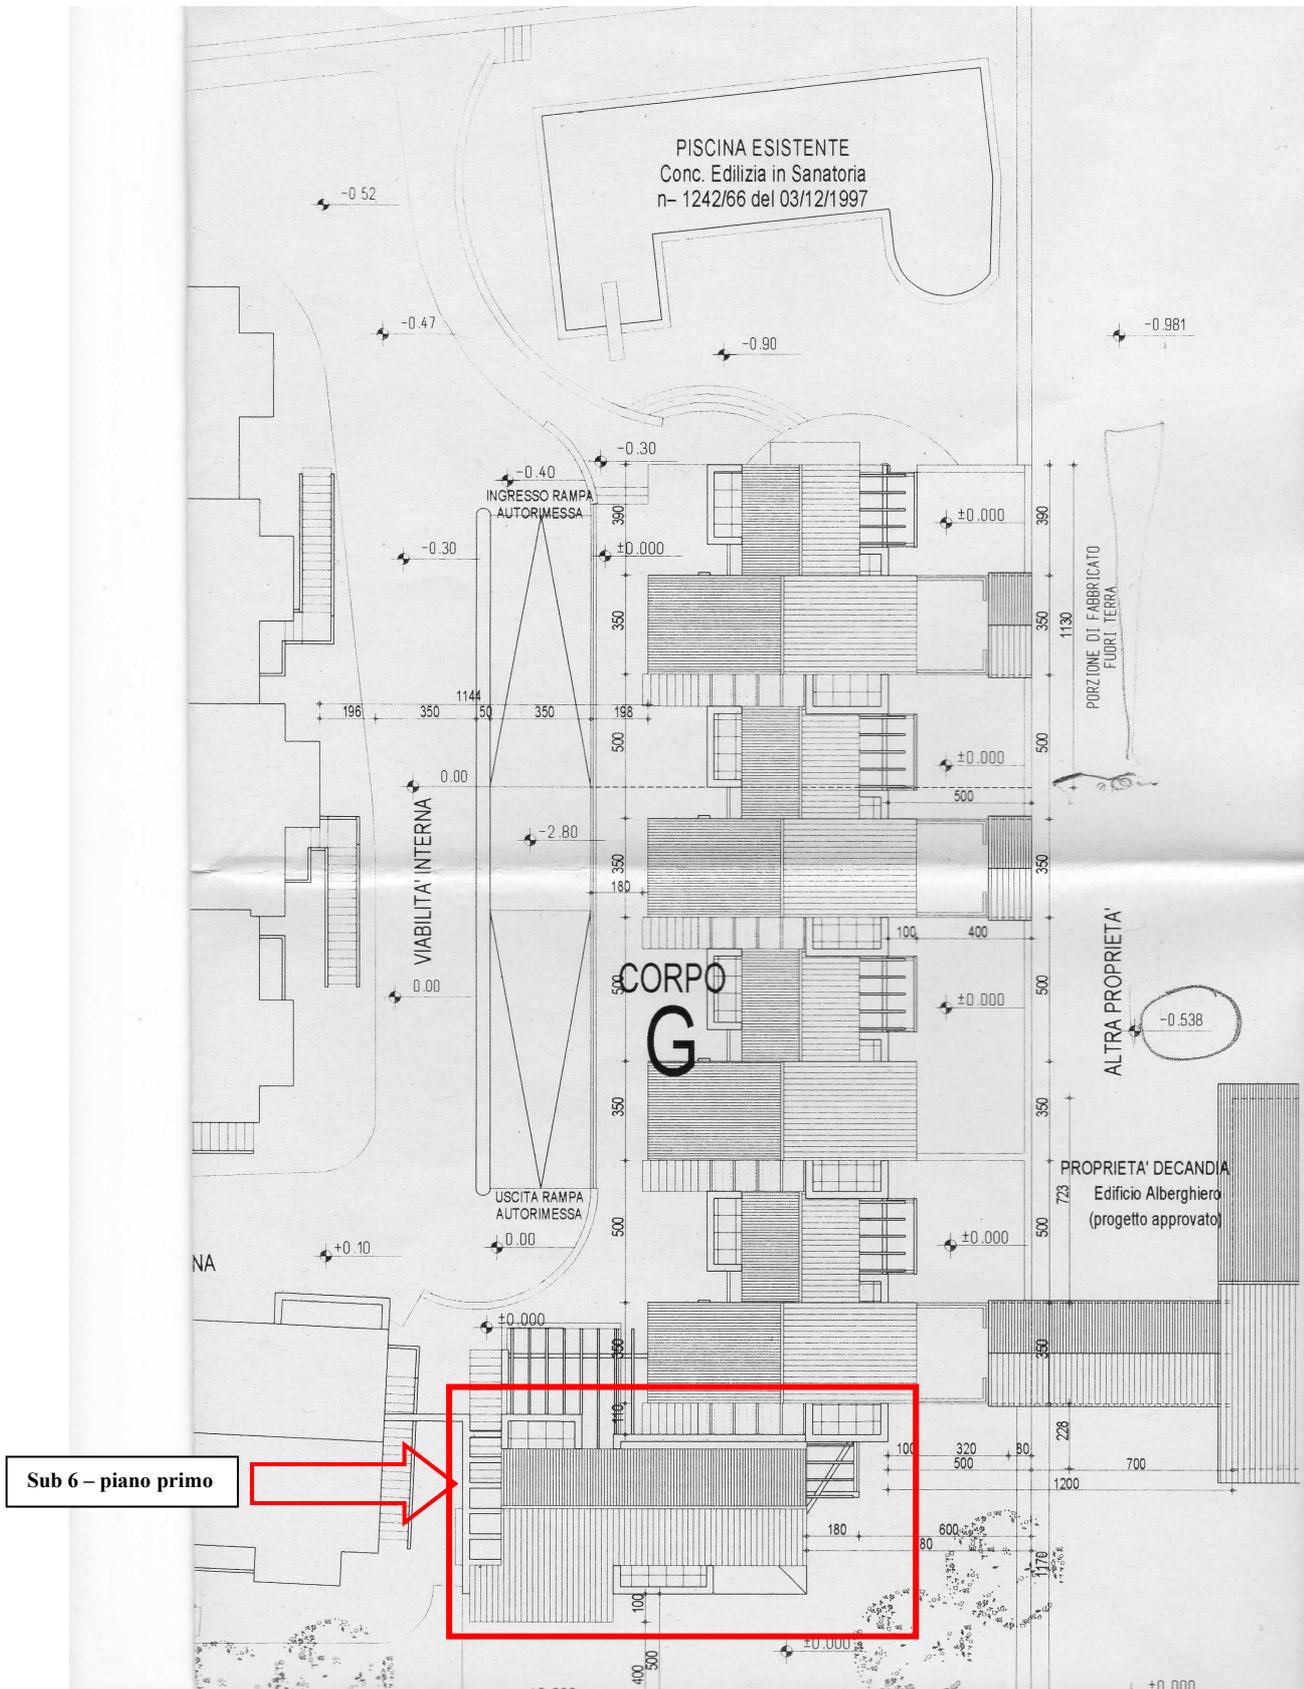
Planimetria del lotto – concessione edilizia 65/2005 del 08/11/2005
